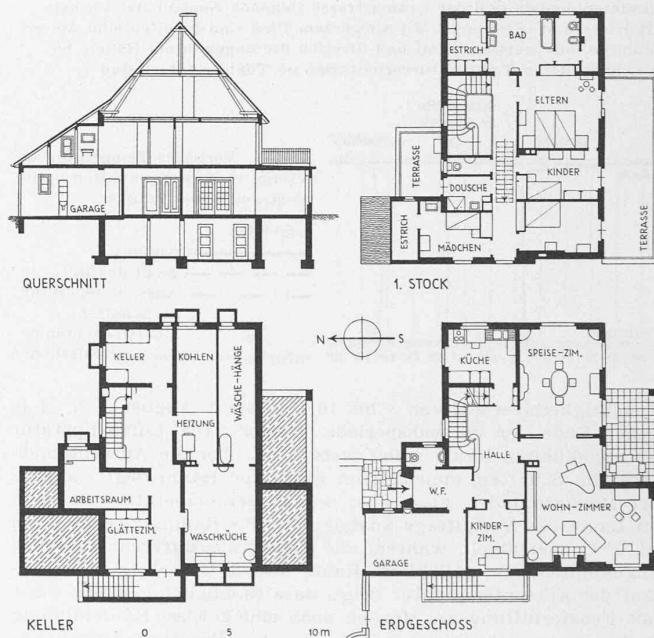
Landhaus Dardel. Grundrisse und Schnitt 1:400
